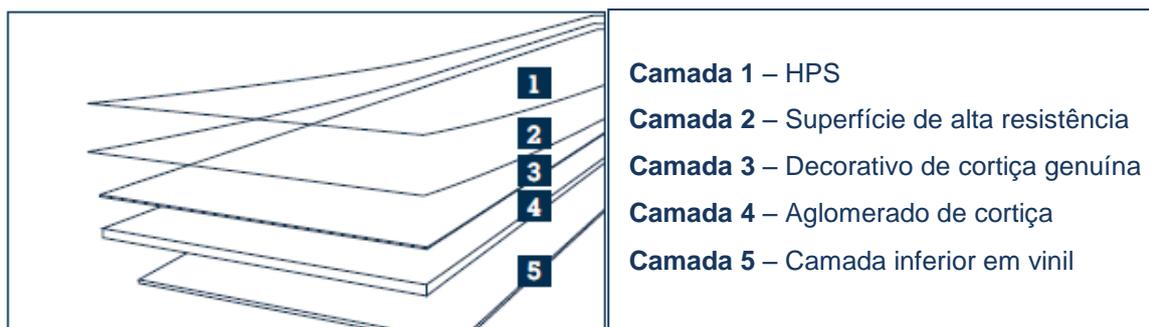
Constituição do Pavimento Colado com HPS [4]
